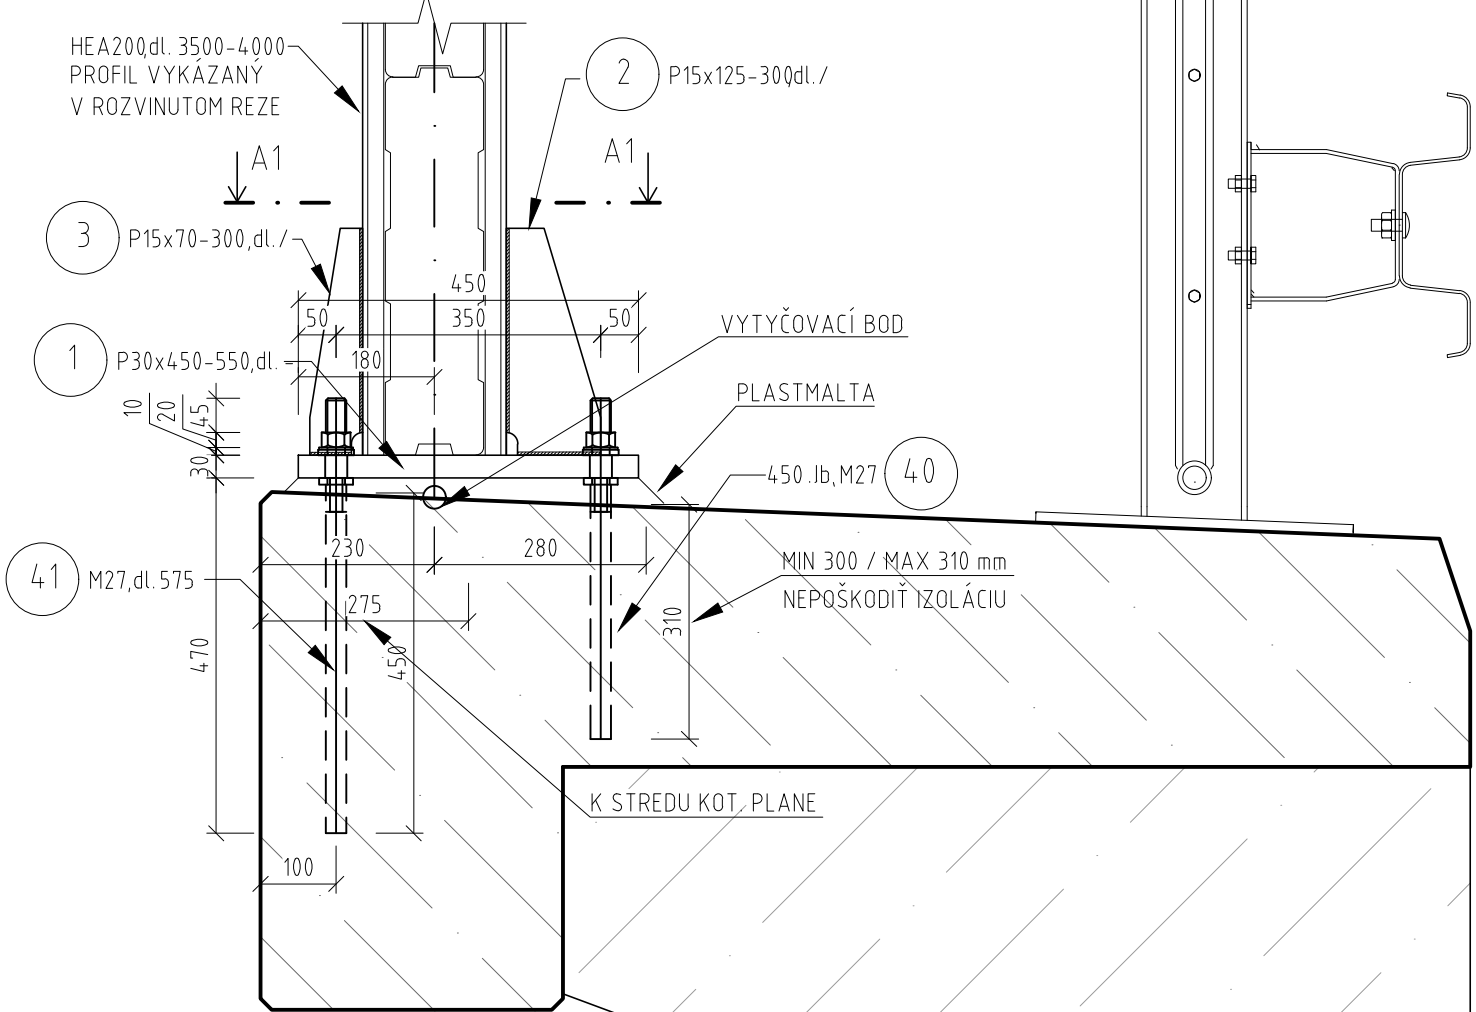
DETAIL ÚPRAVY POZDĽ. ŠKÁRY
